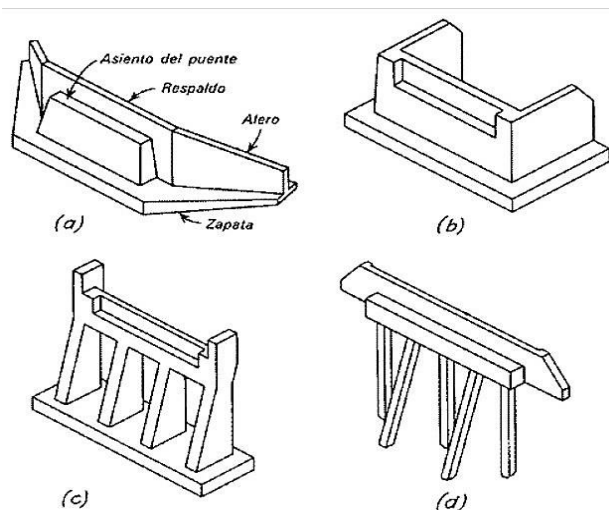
a) Estribo típico de gravedad con aleros b) Estribo en U. c) Estribo sin muro ni aleros d) Estribo de caballete con aleros cortos en cabezal.
